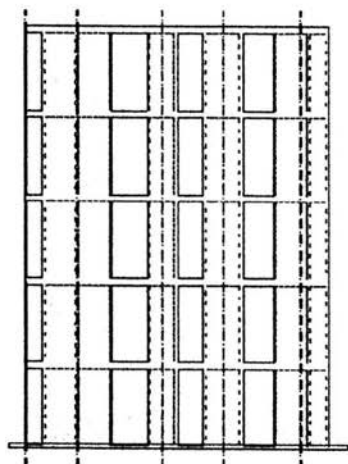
Modelo de marco para muros de mampostería utilizando la analogía de la columna ancha.
